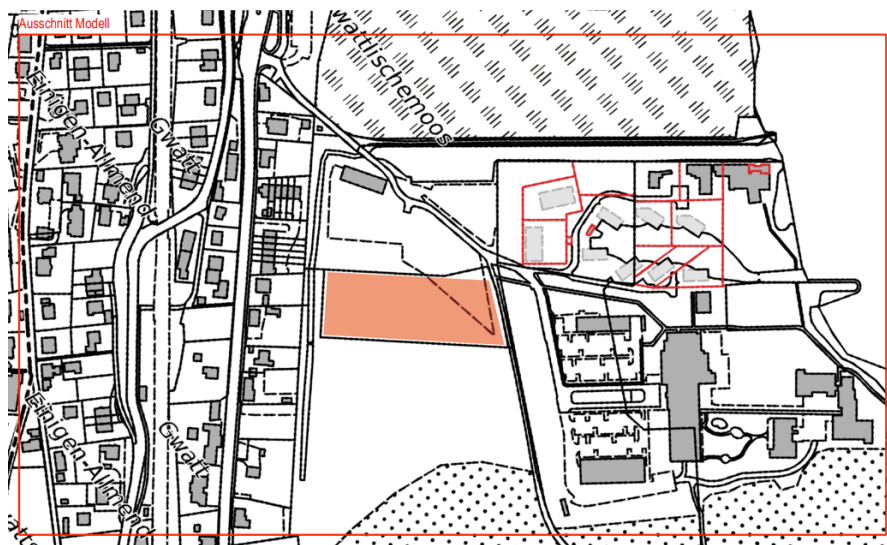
Auszug Plan amtliche Vermessung (rote Fläche: Bearbeitungsperimeter, roter Rahmen: Betrachtungsperimeter Modellausschnitt)
